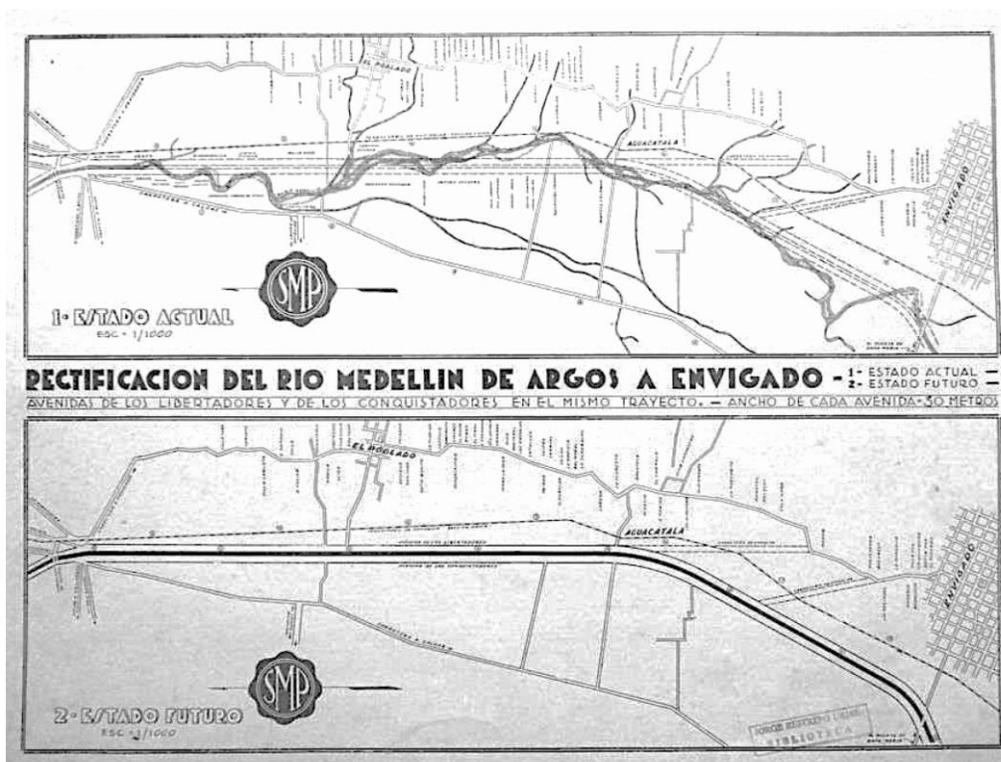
Proyecto original de rectificación del río Medellín entre Envigado y la Planta de Cementos Argos y construcción de la Avenida del Río.
